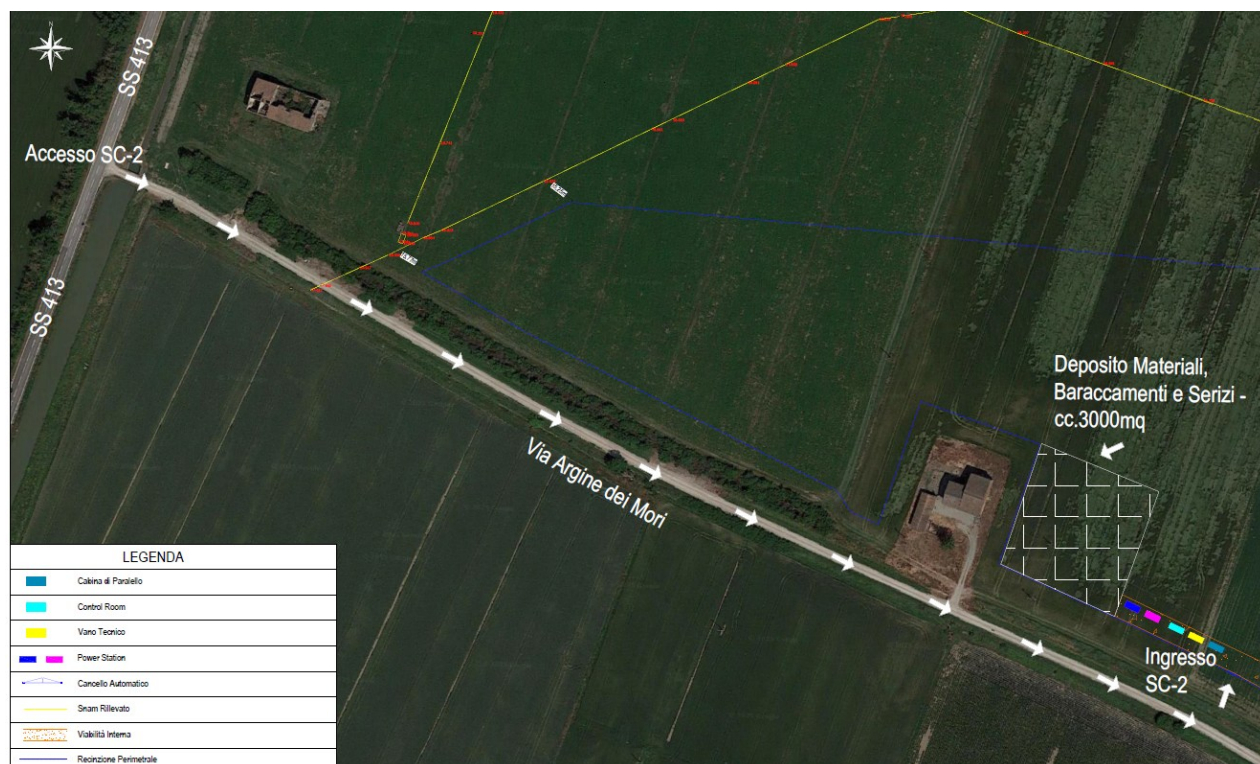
Planimetria delle previste aree di cantiere, inquadramento (sopra) e dettagli delle singole aree (sotto).
